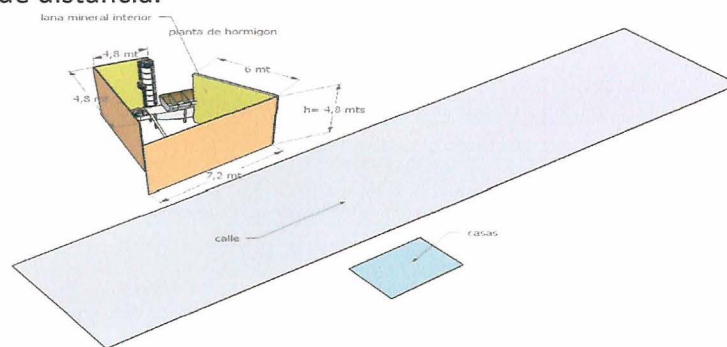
Imagen conceptual, solución acústica planta de hormigón.
